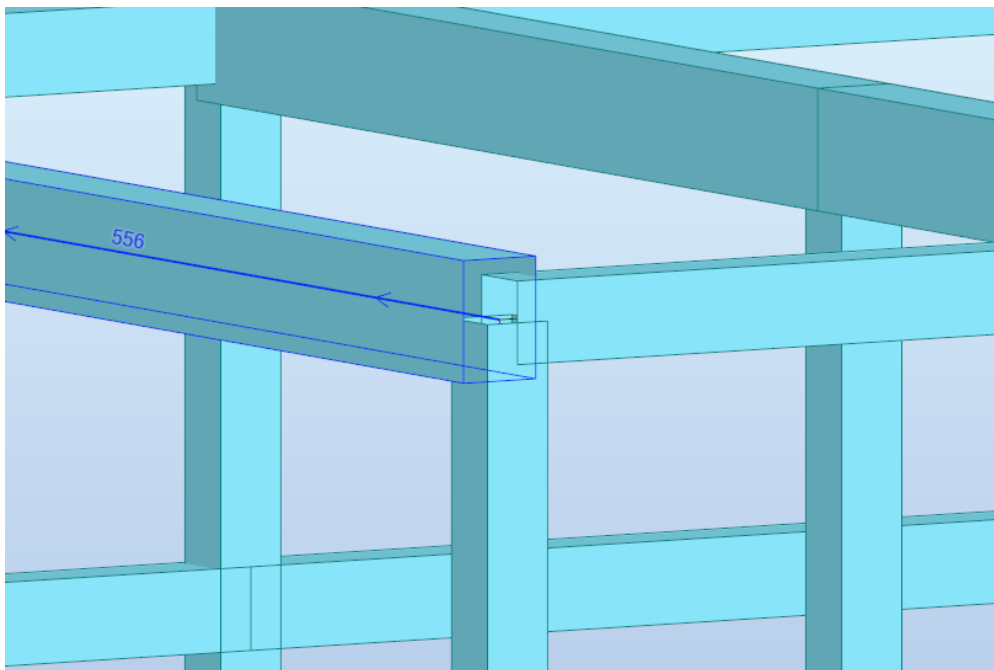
Detalle de las secciones mal situadas en Robot
